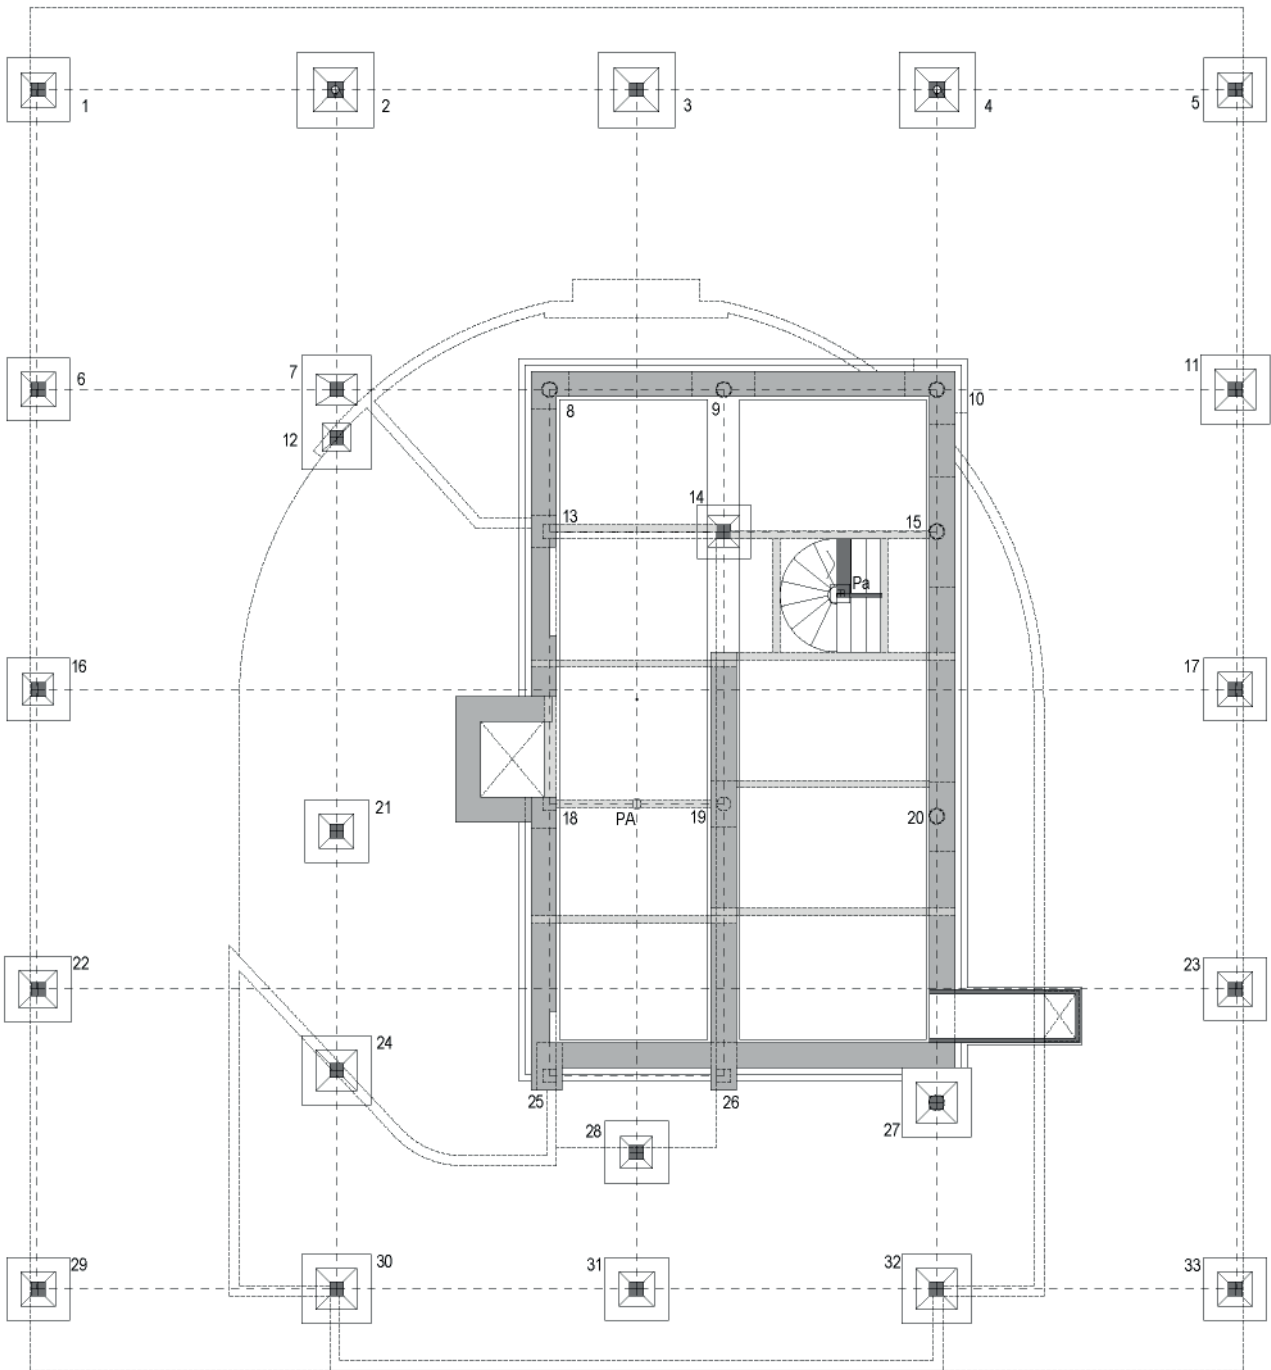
Plano de cimentación y forjado de techo de sótano de la Villa Savoye a escala 1:50. Elaboración propia.
